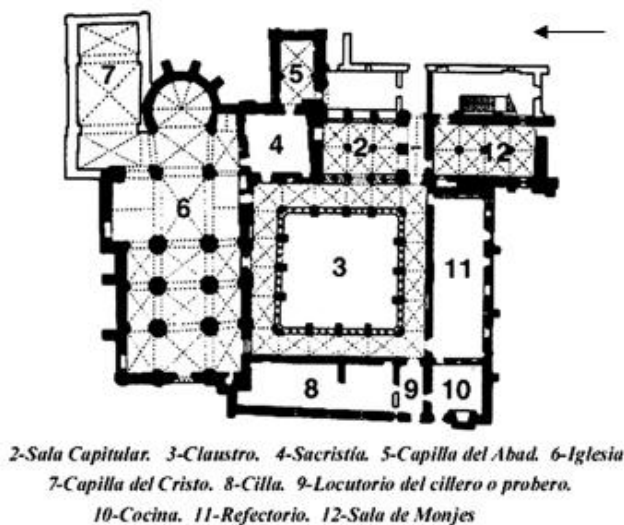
Planta de distribución de Santa María de Aguilar de Campoo. Fuente: Peridis
